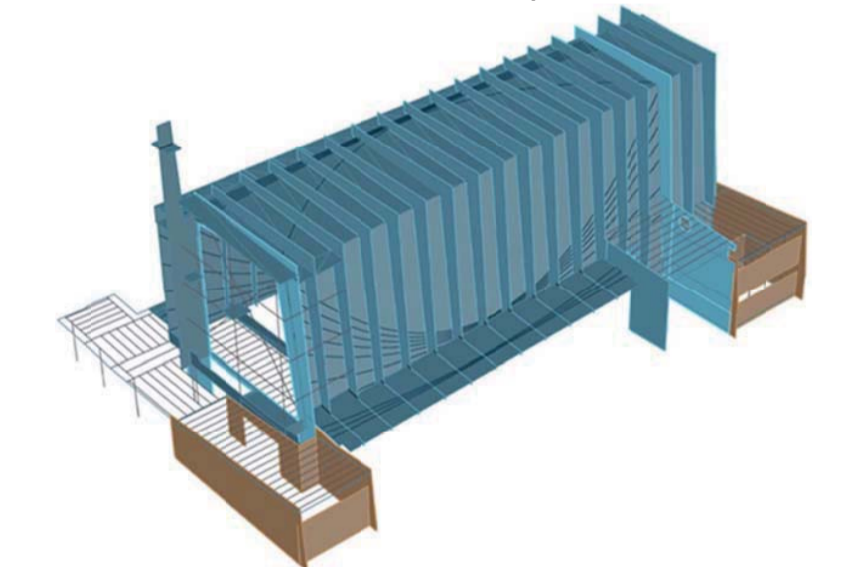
Esquema estructura de la estructura completa: Vista Sur.
